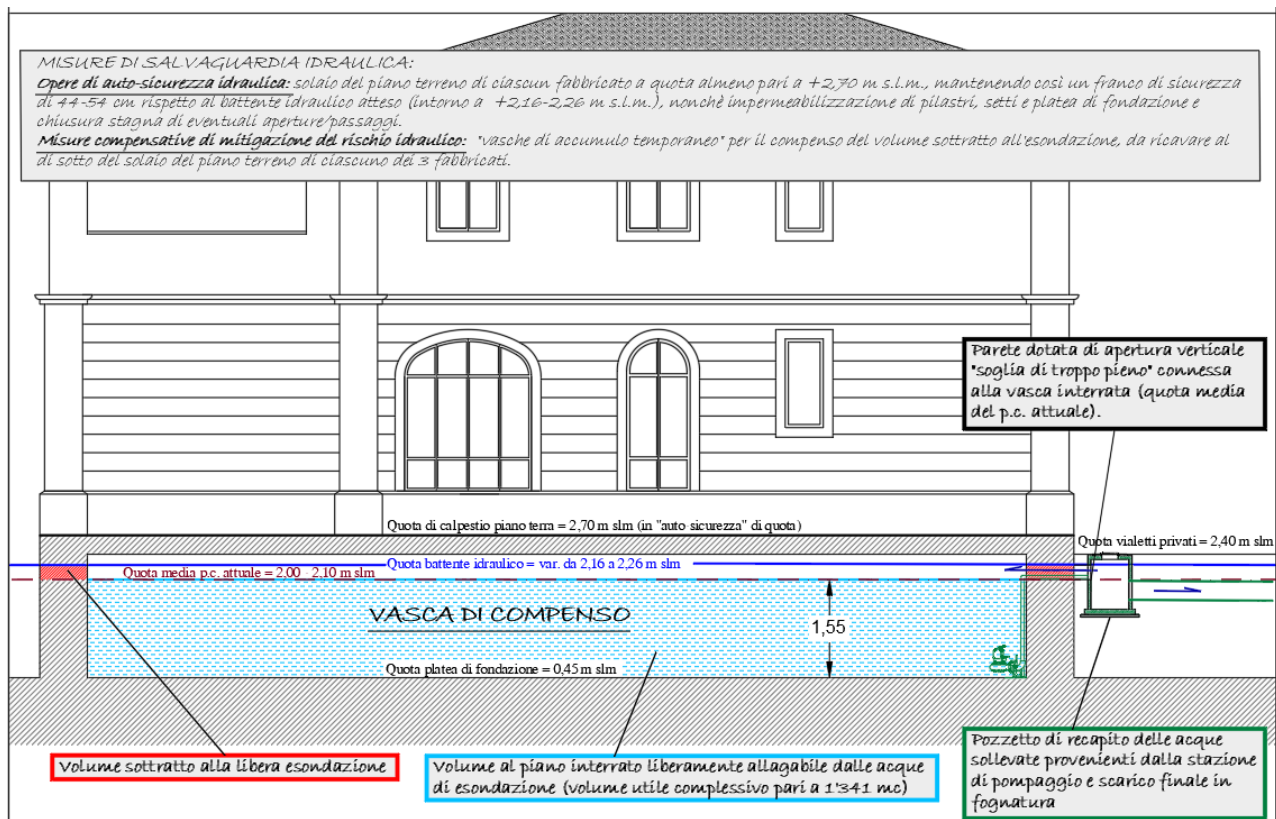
Sezione tipo del piano interrato con indicazione delle quote di progetto.
